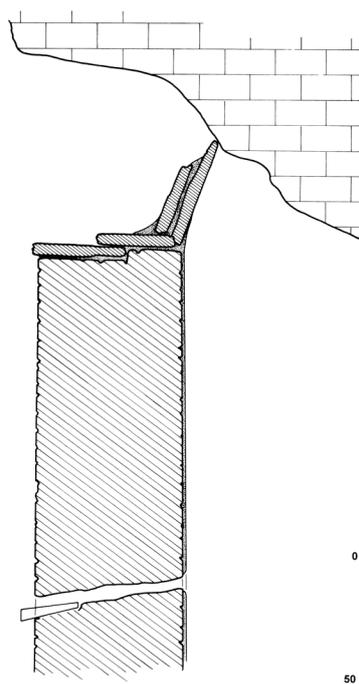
La citerne alimentée par une fissure de l'entablement rocheux vue générale et détail des dalles redressées.
